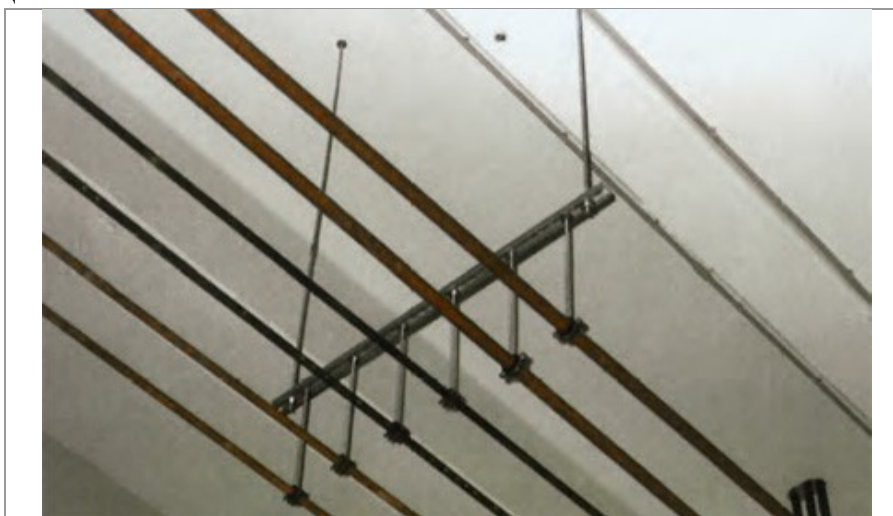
Сейсмоустойчивая подвеска трубопроводов
